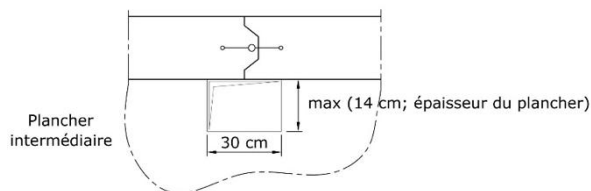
Exemple de trémie dans les planchers au droit des joints J1
